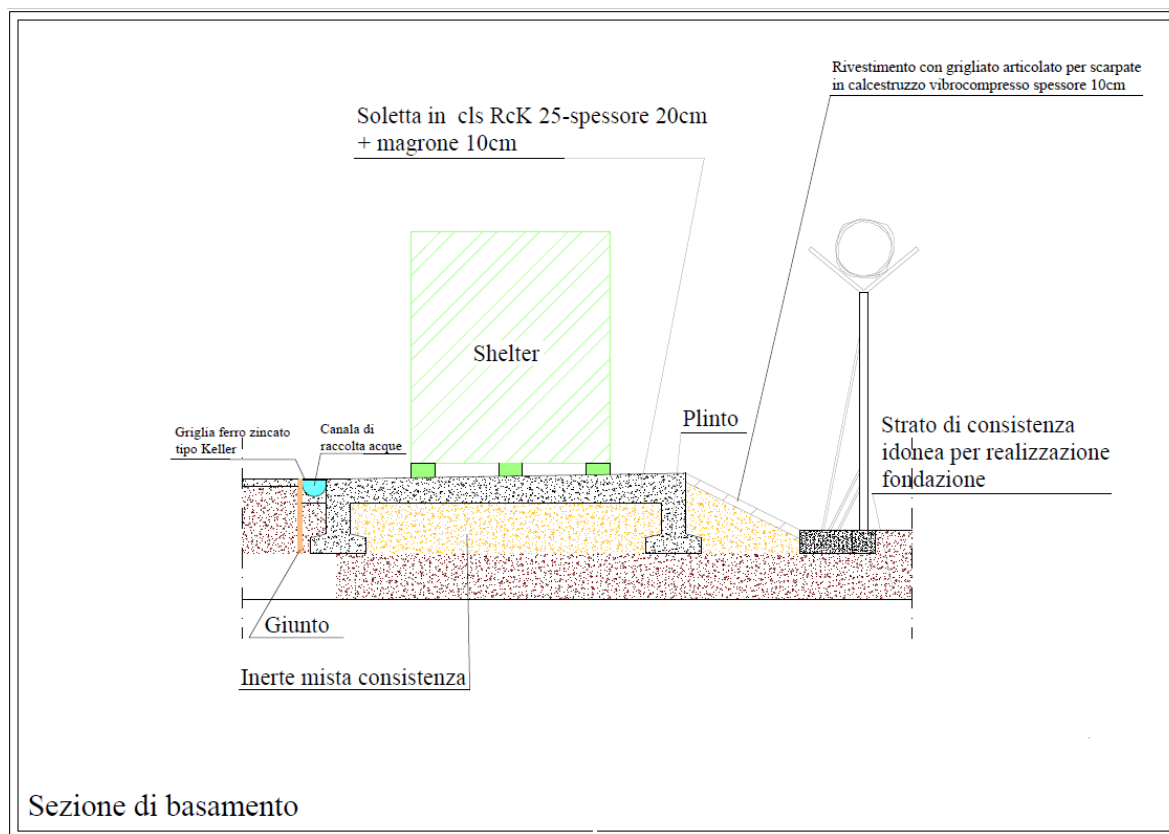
Sezione di basamento della stazione Remrad di Monte S.Angelo
